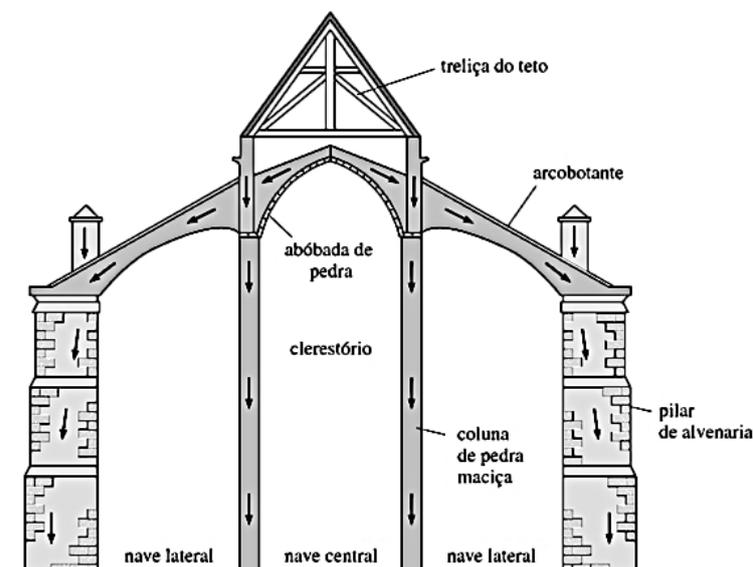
Corte transversal simplificado (LEET; UANG; GILBERT, 2014)
